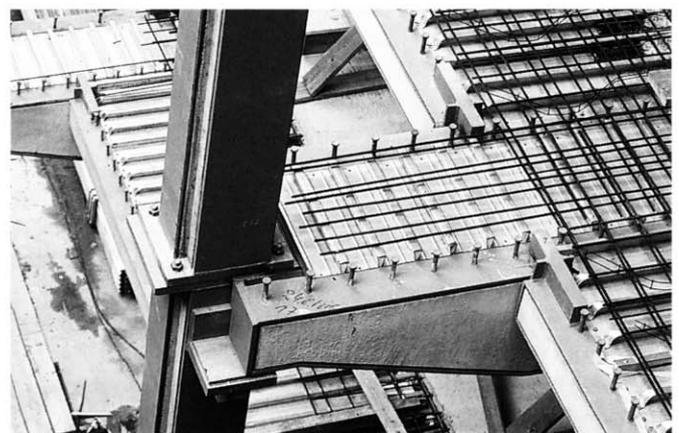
Detailansicht des Konstruktionsaufbaues mit Stütze, Haupt- und Nebenträger, Kopfbolzendübel, Verbundblech, Deckenbewehrung
